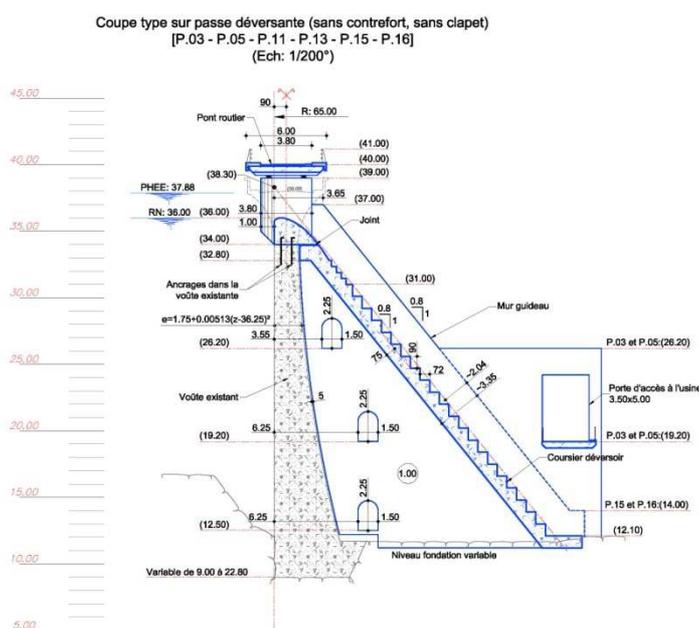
Coupe type du barrage projeté – sans contrefort et passe non vannée.
